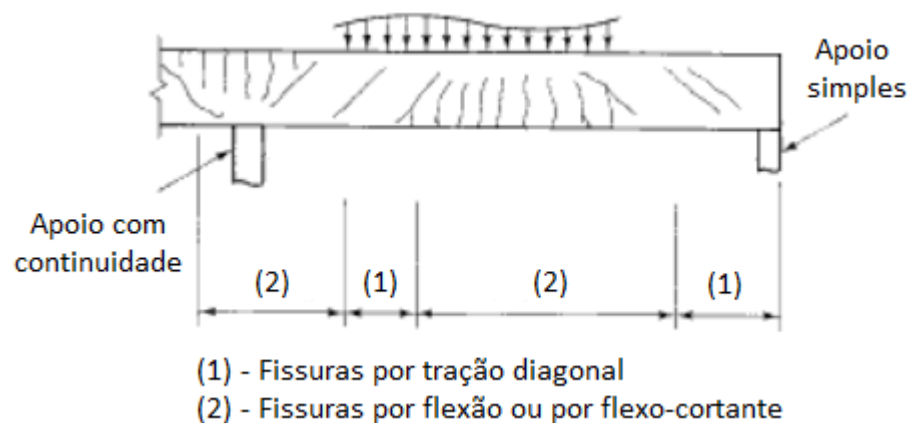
Fissuração de vigas contínuas sujeitas a cargas concentradas (FUSCO (2008)).
